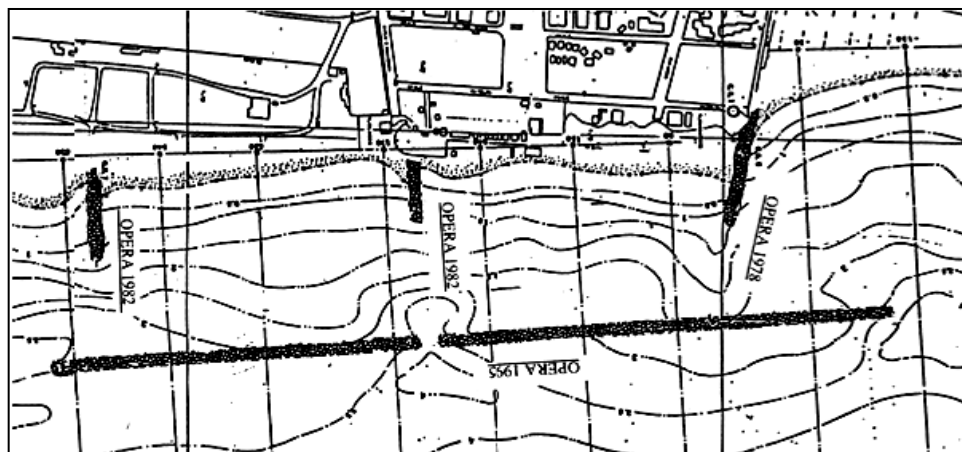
Planta elucidativa das estruturas submersas construídas em Lido di Dante (Delos, 2003a)
